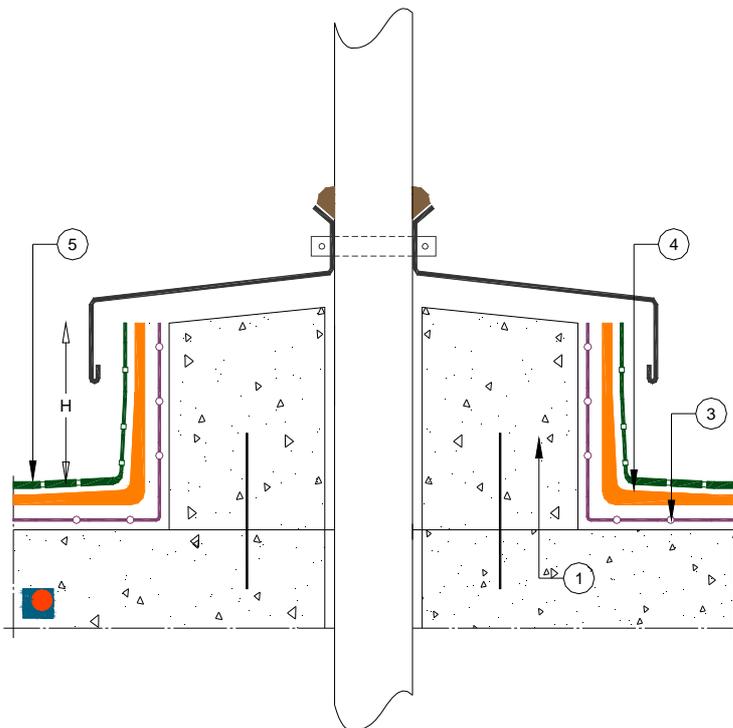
Traversée avec un dé en béton (en zone accessible)
